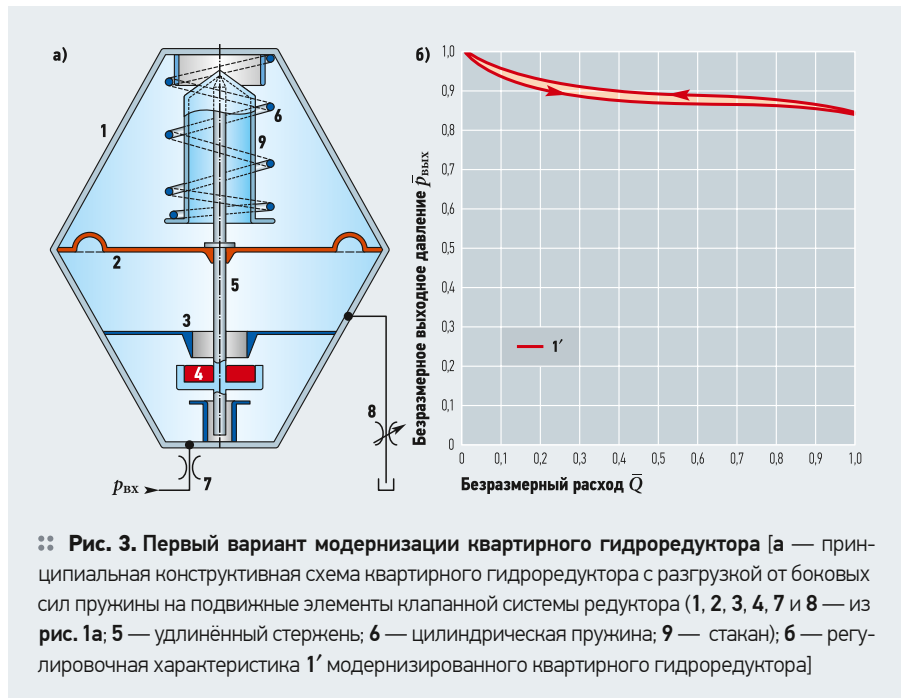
Первый вариант модернизации квартирного гидроредуктора [а — принципиальная конструктивная схема квартирного гидроредуктора с разгрузкой от боковых сил пружины на подвижные элементы клапанной системы редуктора (1, 2, 3, 4, 7 и 8 — из рис. 1а; 5 — удлинённый стержень; 6 — цилиндрическая пружина; 9 — стакан); 6 — регулировочная характеристика 1' модернизированного квартирного гидроредуктора]
